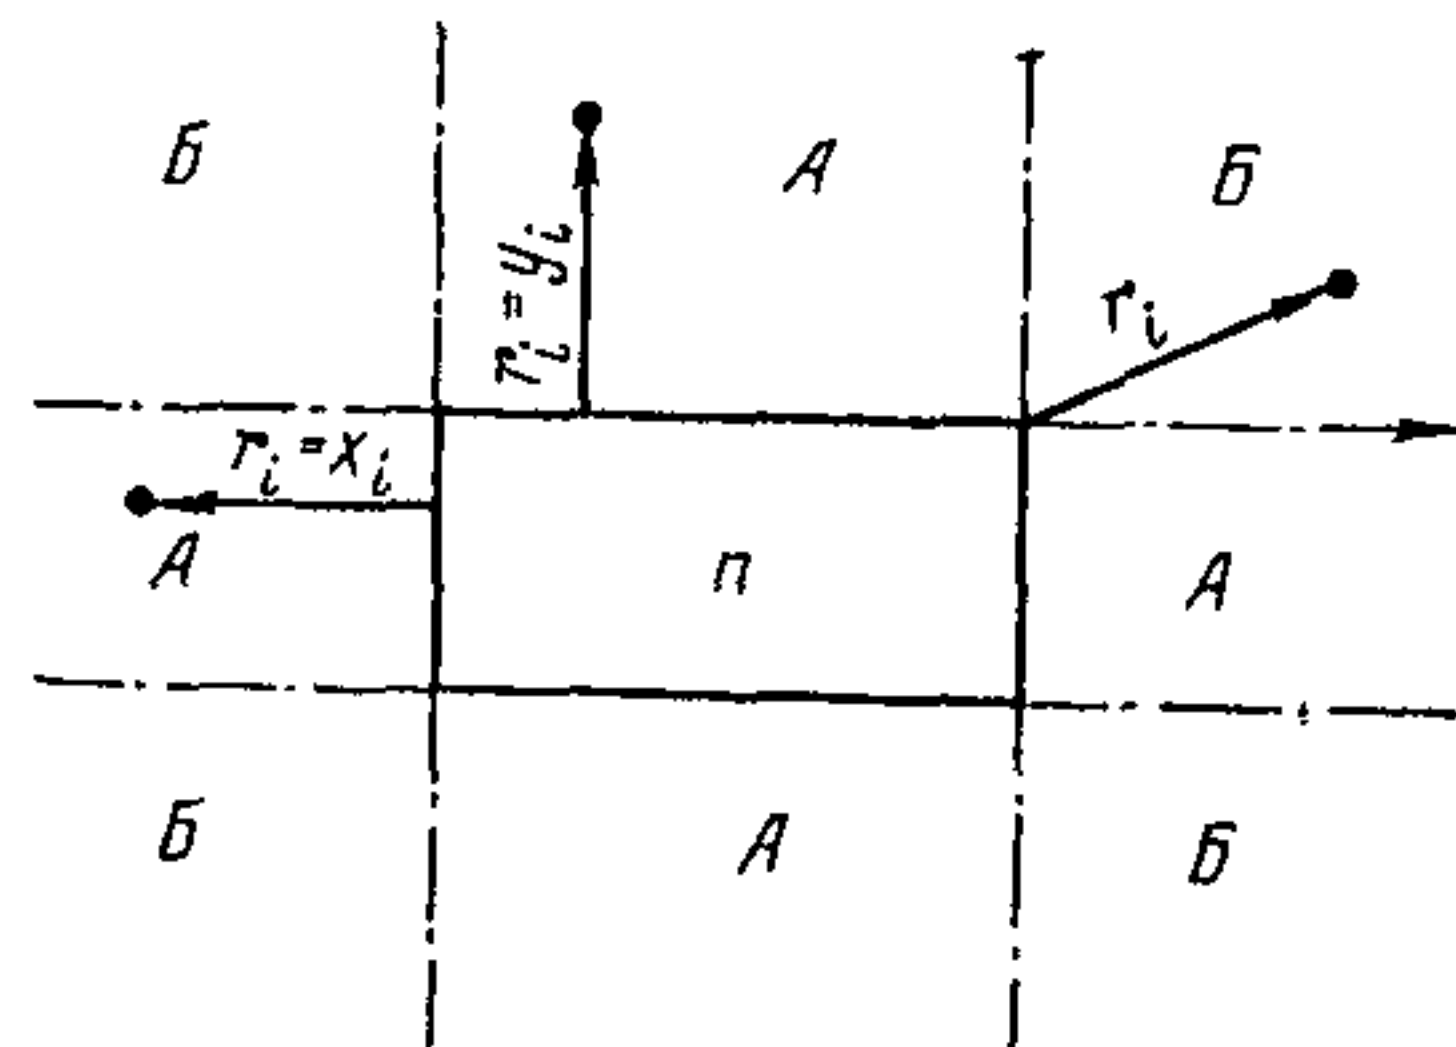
Взаимное расположение зон основания, примыкающих к фундаментной плите
